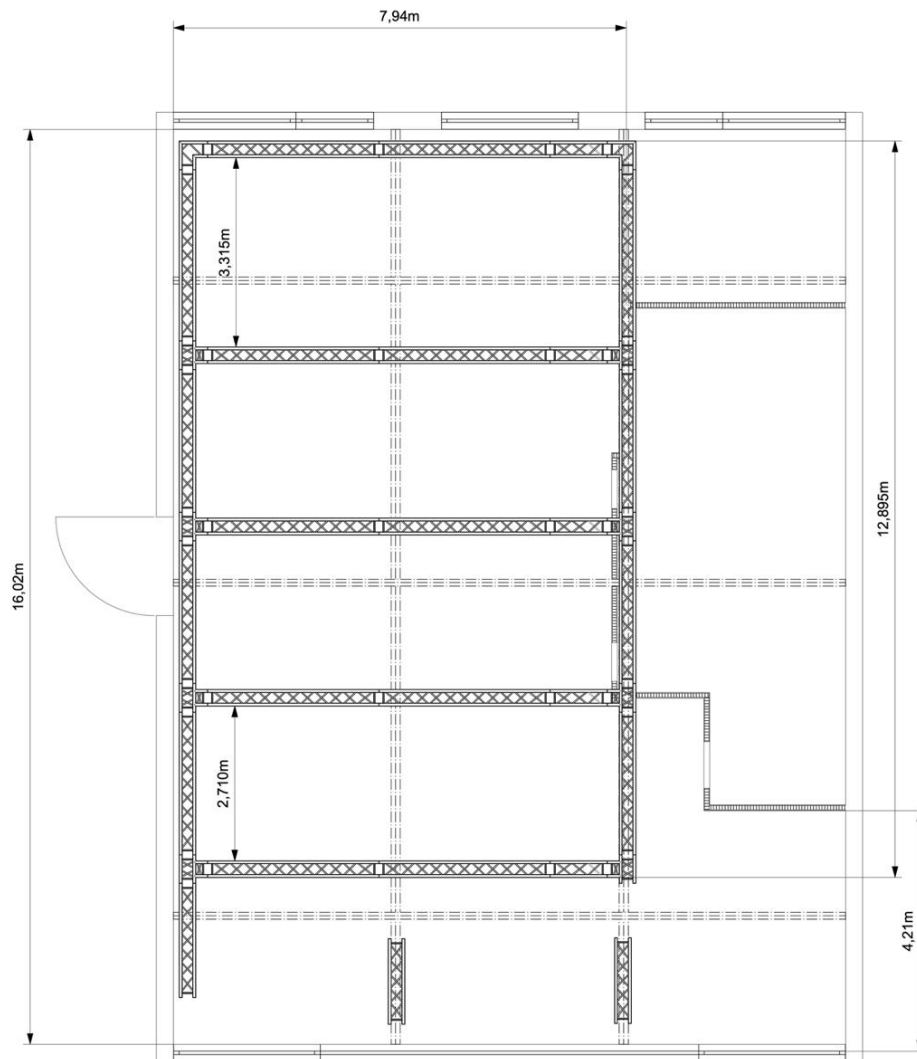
Grundriss Production Lab (Ligeti Center, [2026](#))
